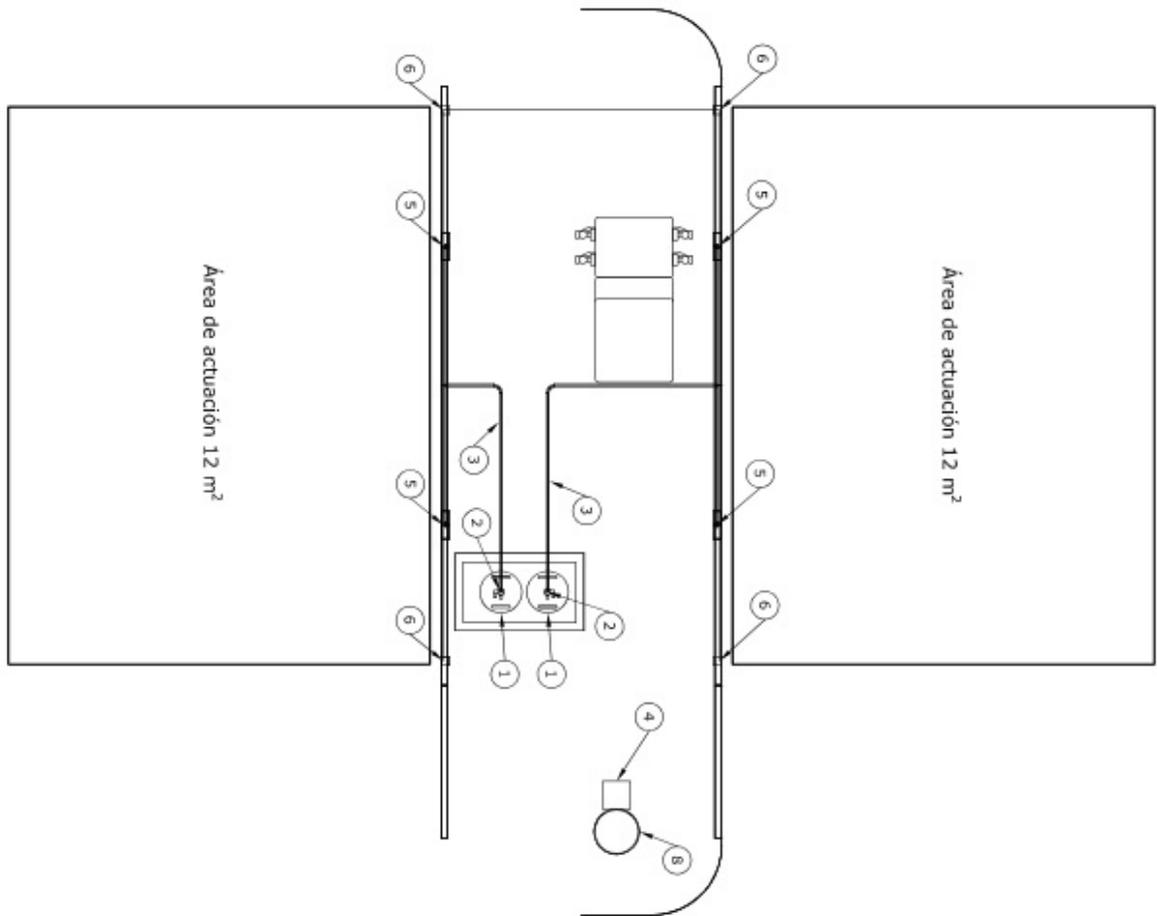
Disposición de los elementos del sistema KIT PETCI, visto en planta
